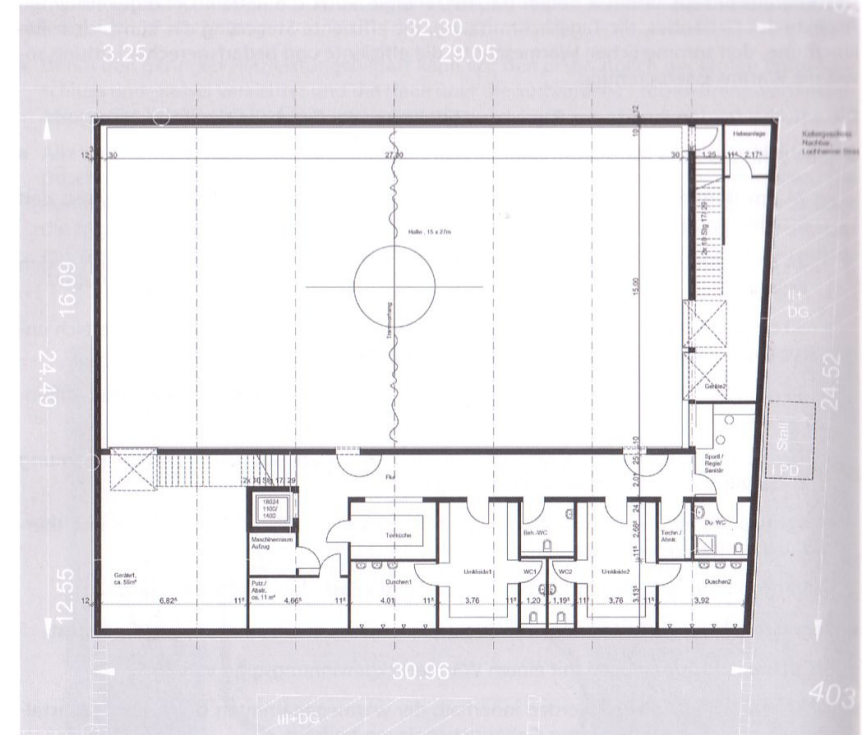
Grundriss des Untergeschosses, d. h. der Hallenebene (Norden liegt oben)
